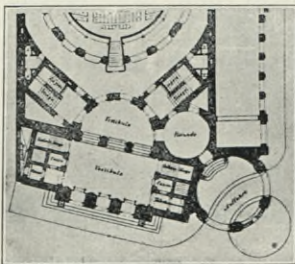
Stadttheater zu Wien. Grundriß des Vorderhauses.<sup>68)</sup>
